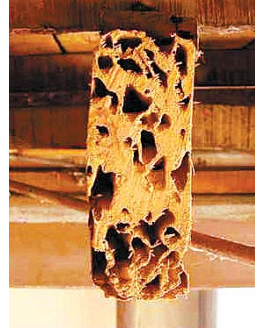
Viga con galerías de *Cryptotermes brevis*.
